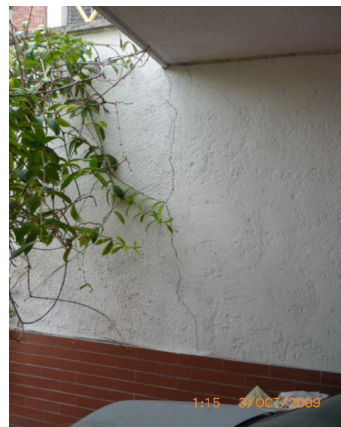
Fisura de muro Casa-Tramonti
